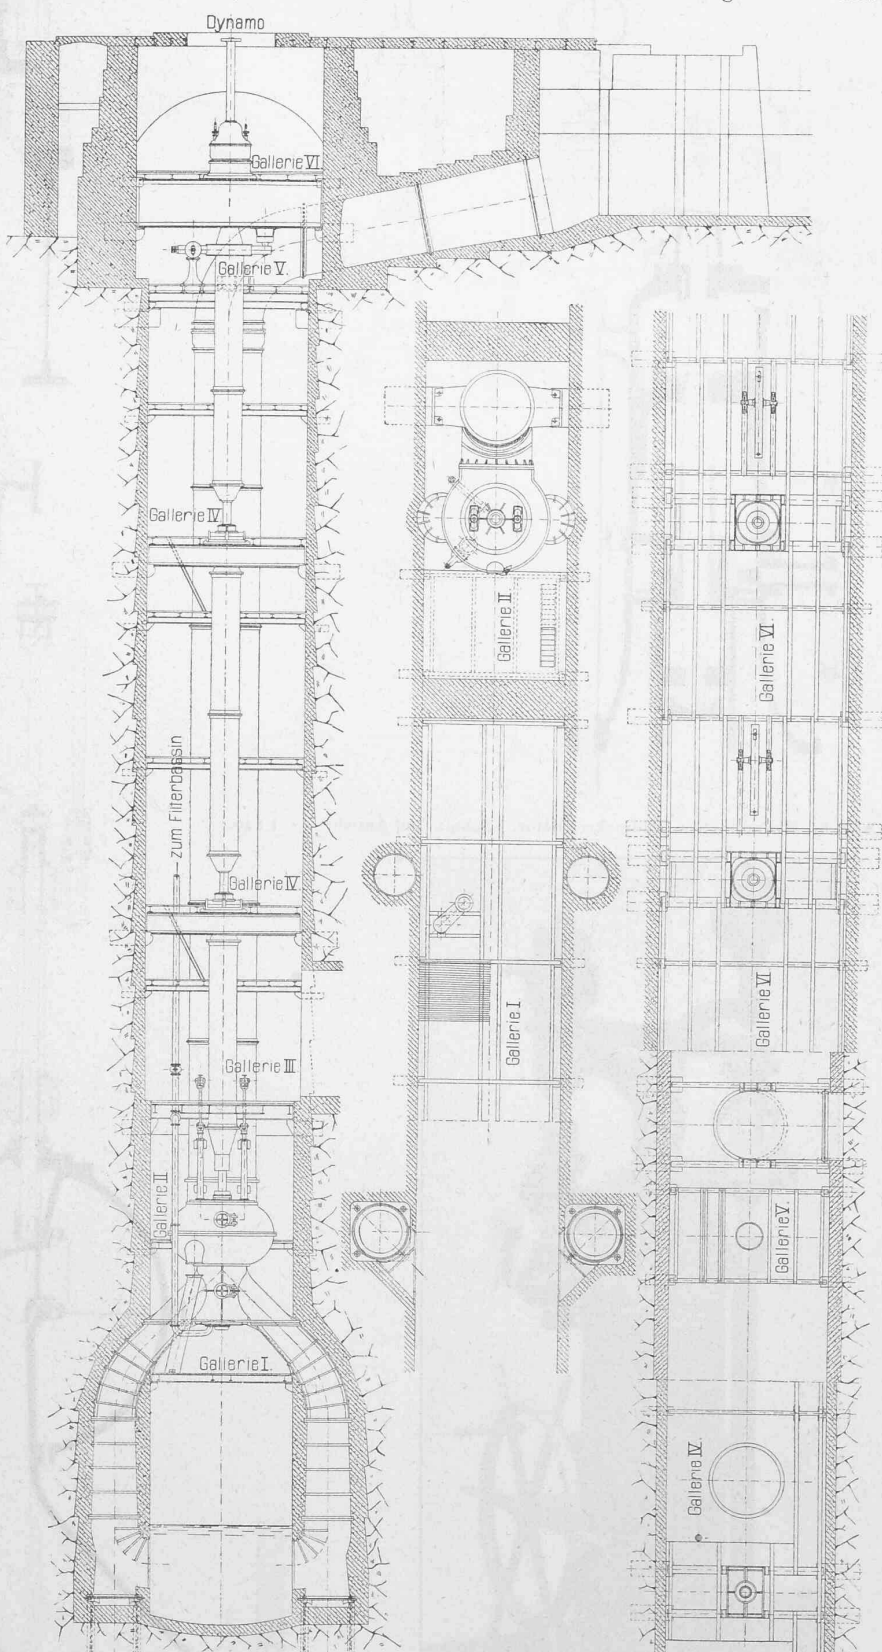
Querschnitt des Turbinenschachtes und Grundriss der Zwischenböden. 1:250.
